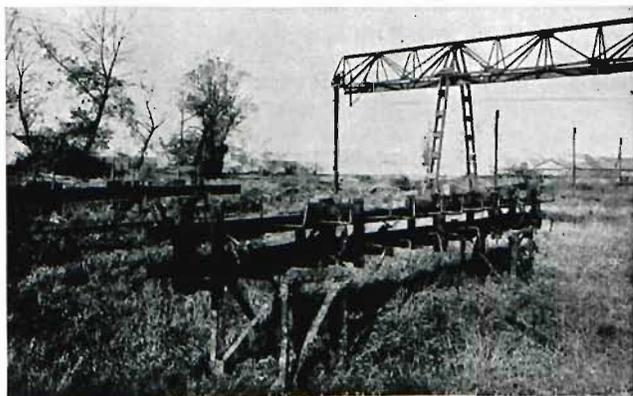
Dispositif pour l'assemblage par soudure des poutres en tôle du plancher.
